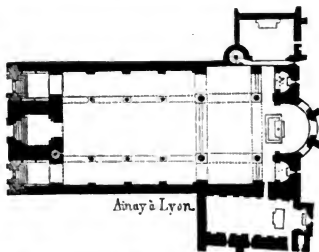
Grundriss der Kirche von Ainay zu Lyon.
